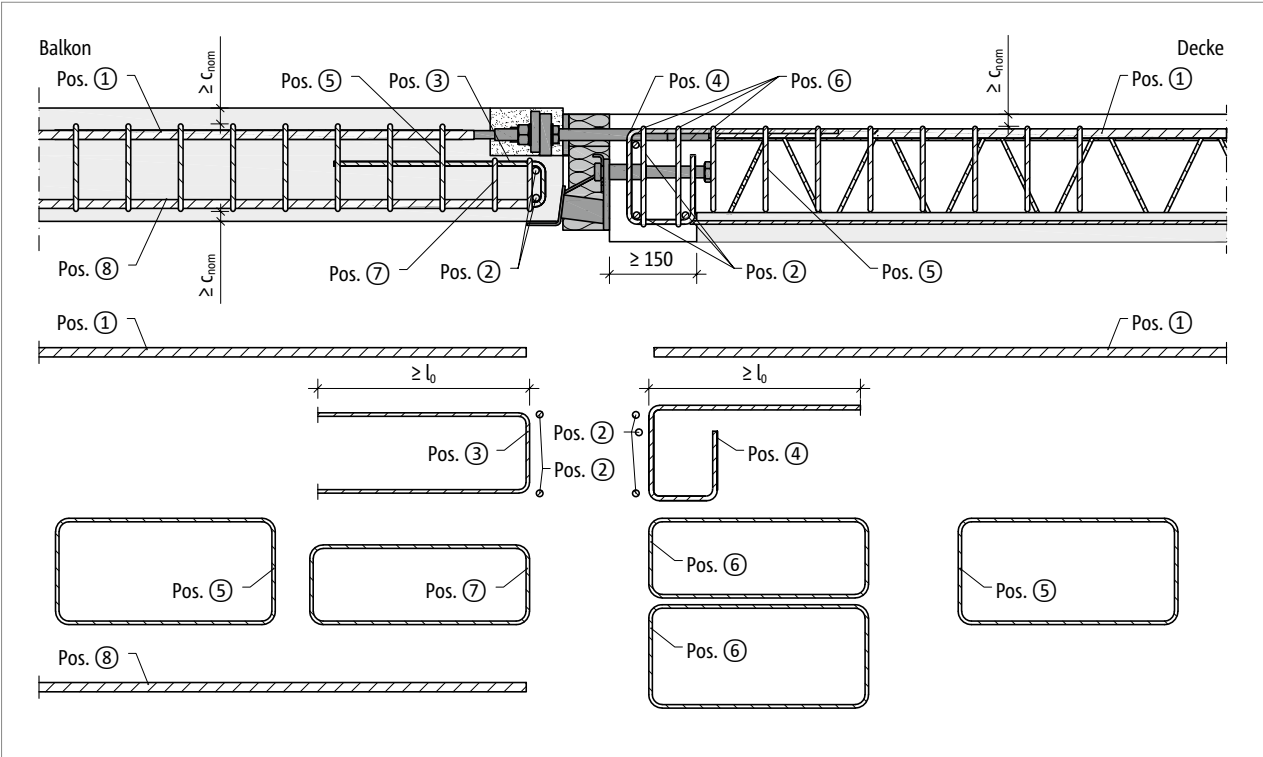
Schöck Isokorb® IQ Typ K-B: Bauseitige Bewehrung mit Gitterträger
